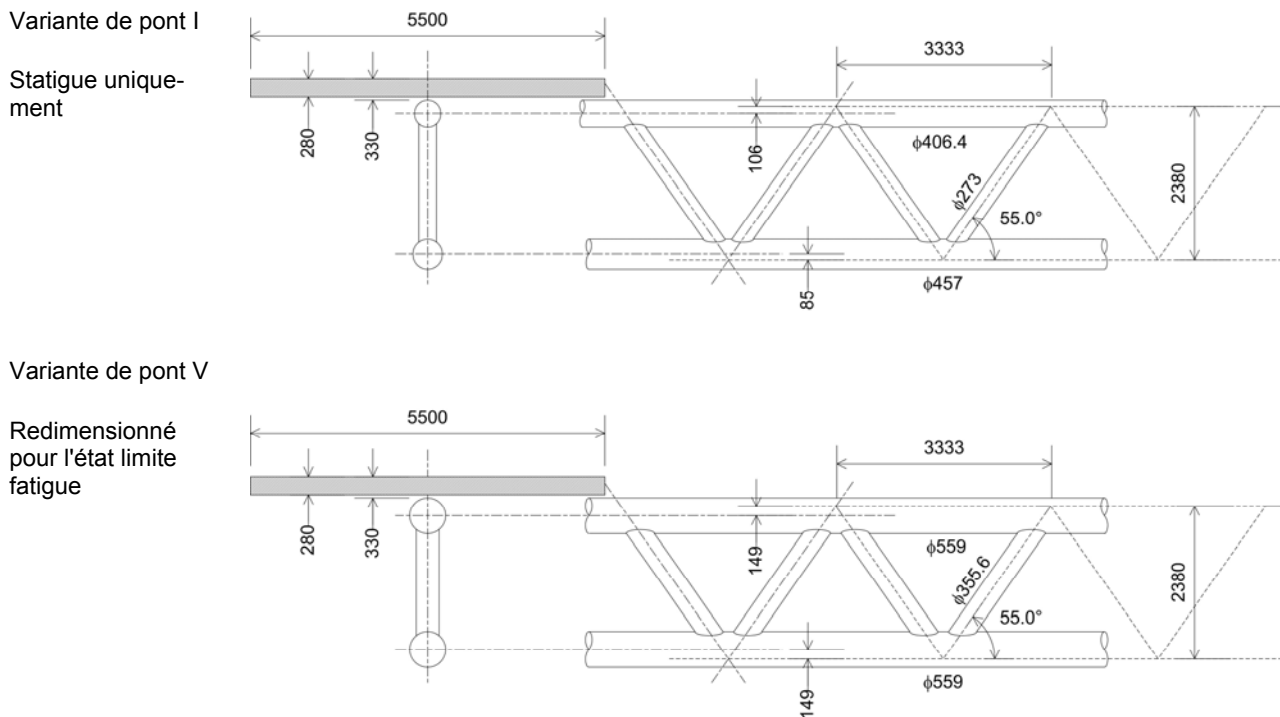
Vue et coupe d'une section de deux variantes du pont-route type
